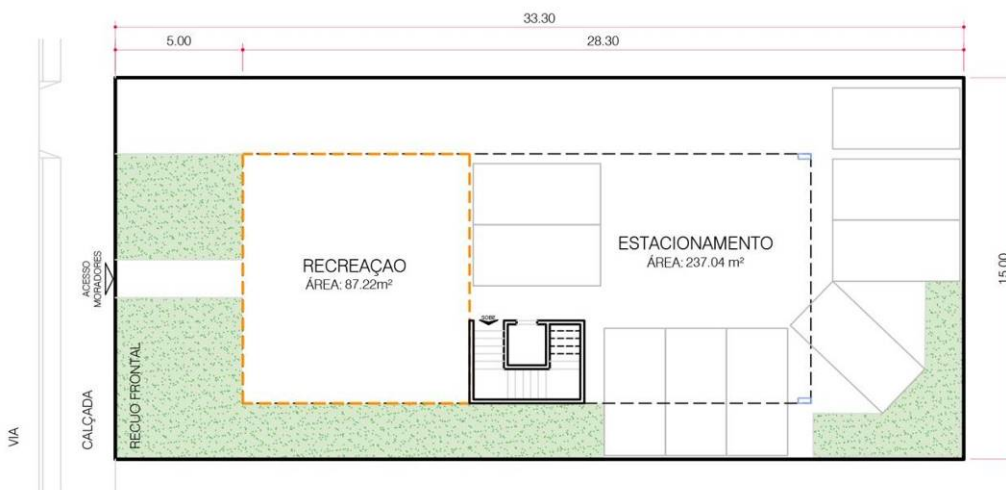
Plantas baixas e corte de edifício residencial em lote de 500m²
